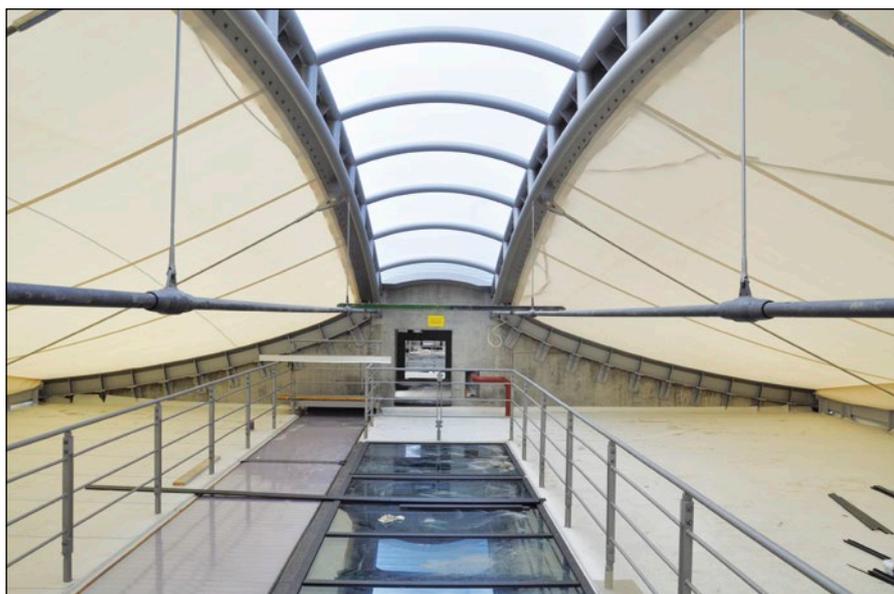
Transparente Dachkonstruktion aus Membranen mit Tageslichtelement.
